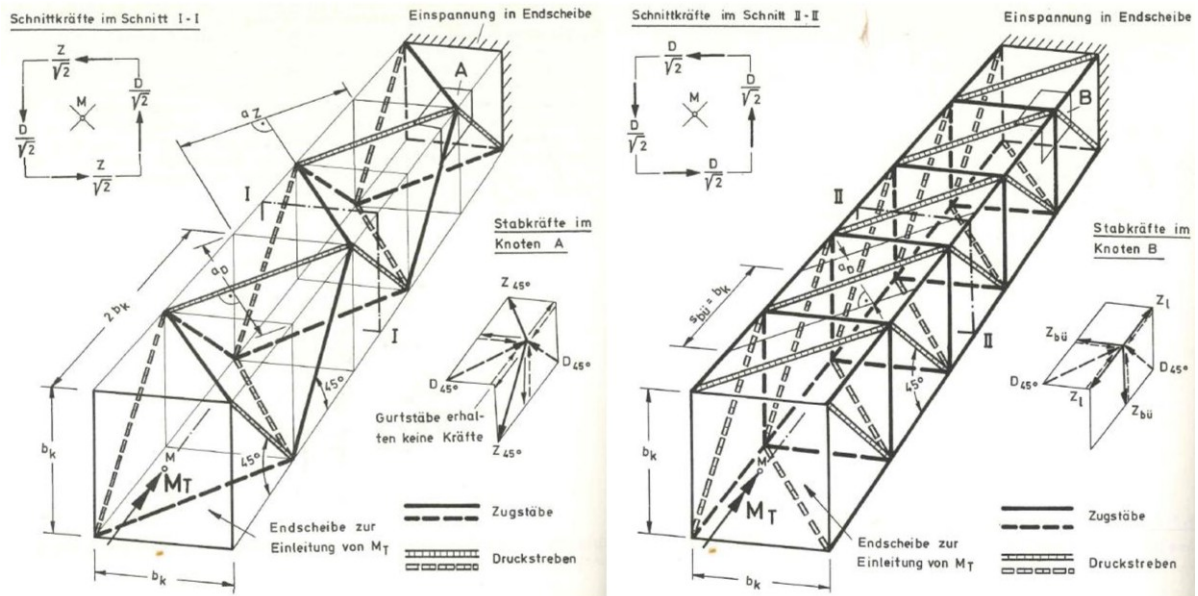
Räumliches Fachwerk bei reiner Torsion, links: Torsionsbewehrung kongruent zur Hauptzugspannung, rechts: Torsionsbewehrung mit 90°-Bügel, entnommen aus [55]
